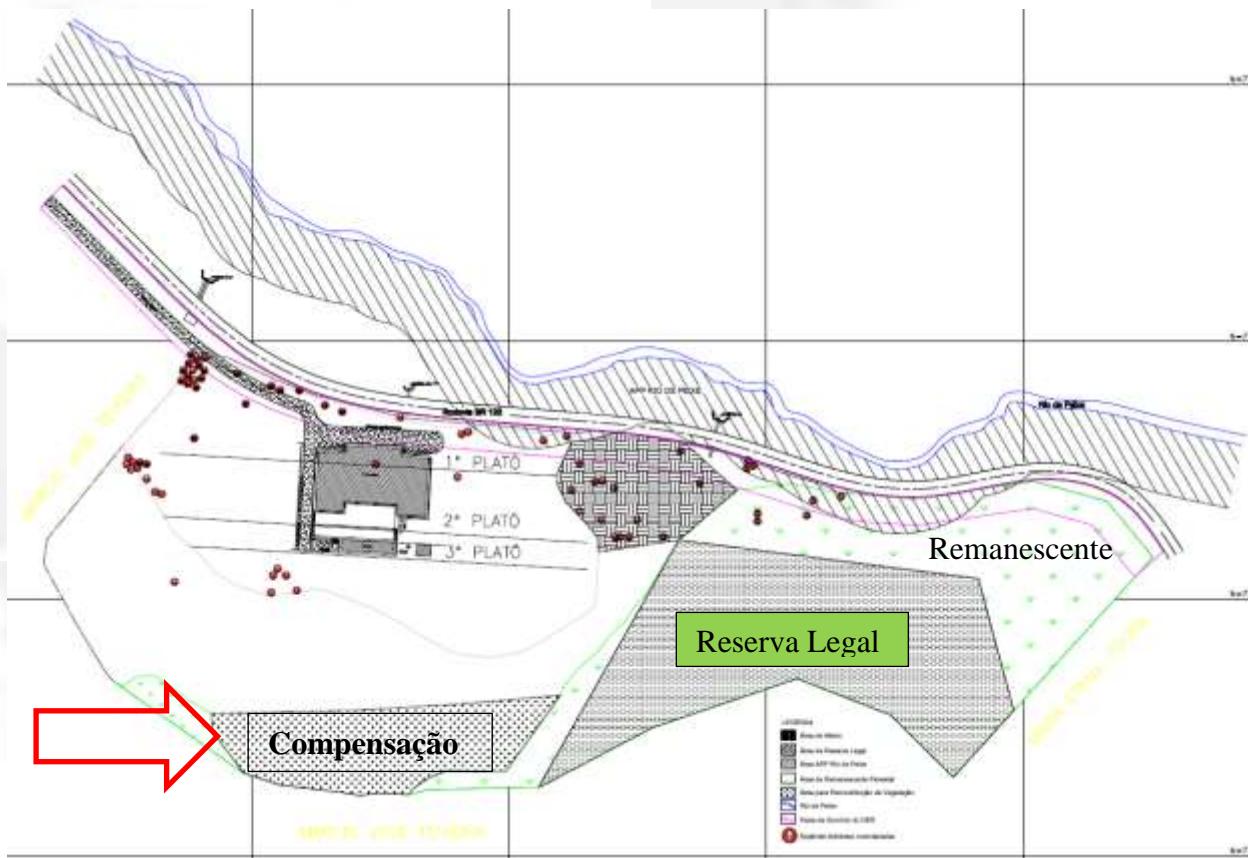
Planta com indicação da área de compensação florestal localizada próximo a área de reserva legal da propriedade
